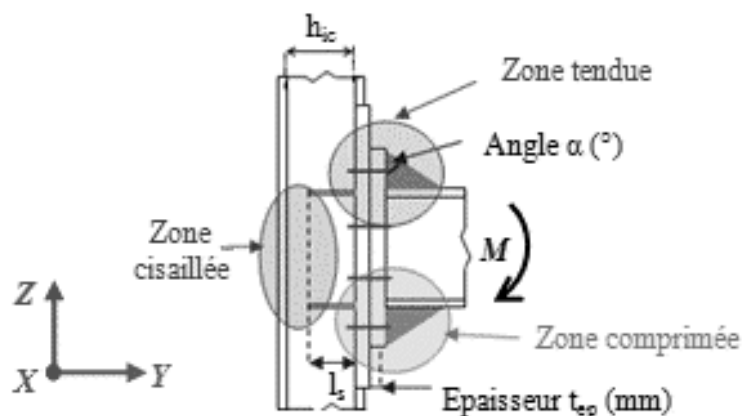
Zones critiques dans les assemblages poteau-poutre [51]
